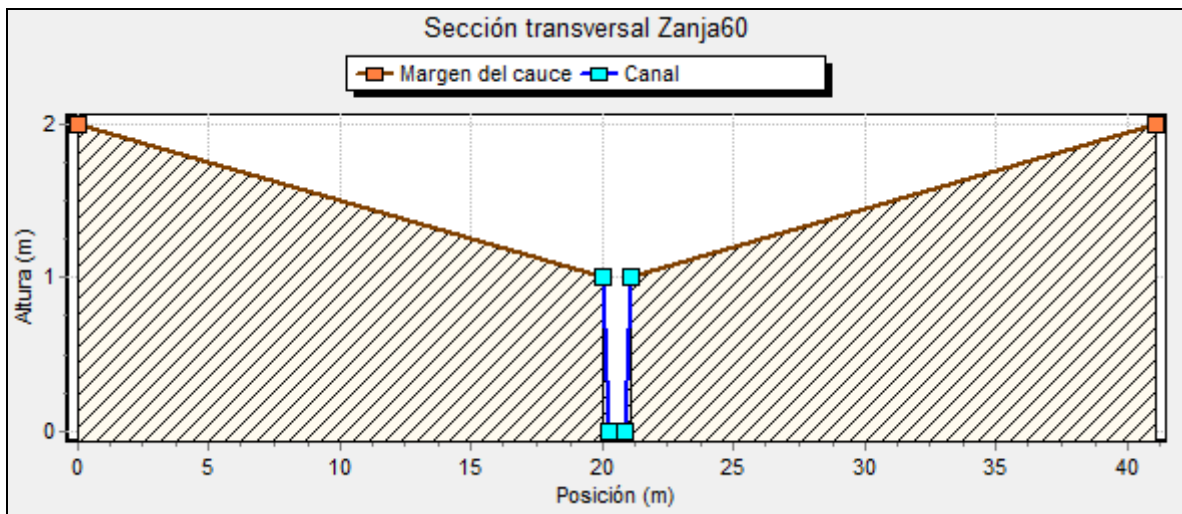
Sección transversal de zanjas excavadas en tierra de 60cm de ancho de solera.
